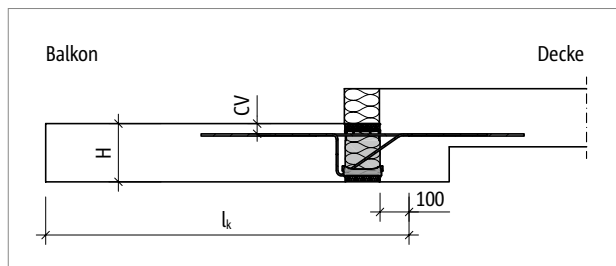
Schöck Isokorb® XT Typ KL-M1 bis M8: Statisches System
